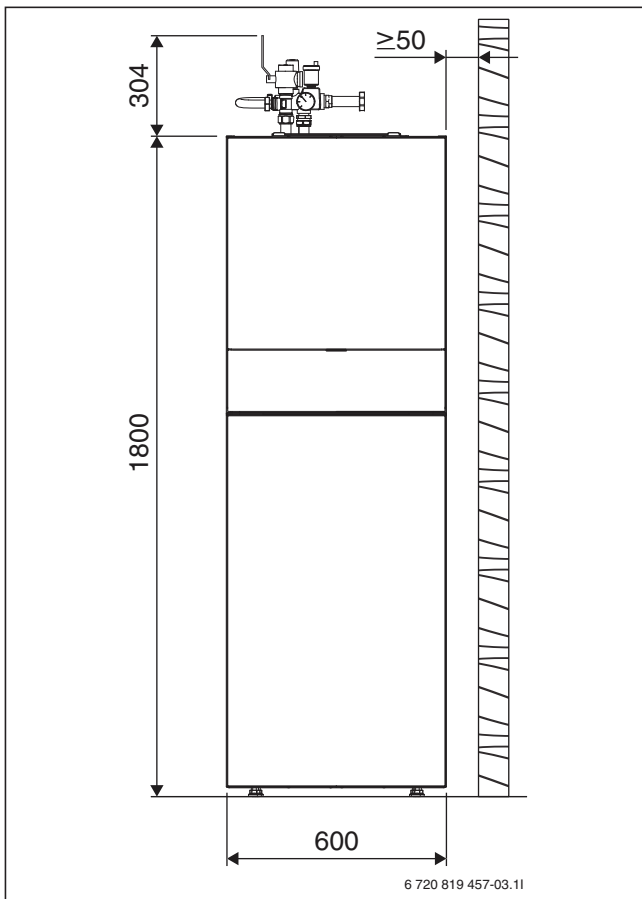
Abmessungen und Mindestabstände des Towers, Frontalansicht (Maße in mm)
